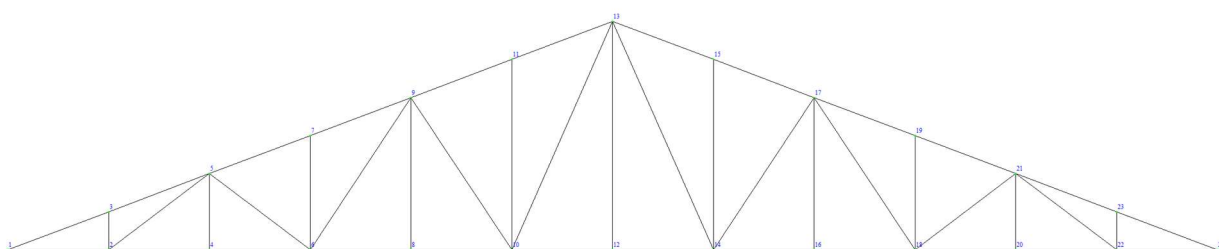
Расчетная схема фермы с нумерацией узлов
